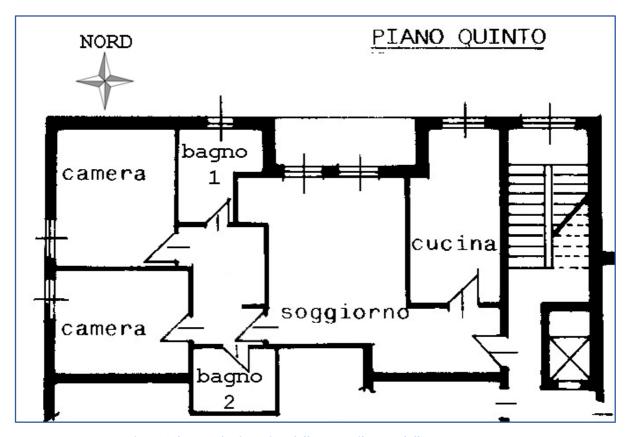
Schema planimetrico dello stato rilevato dell'appartamento
